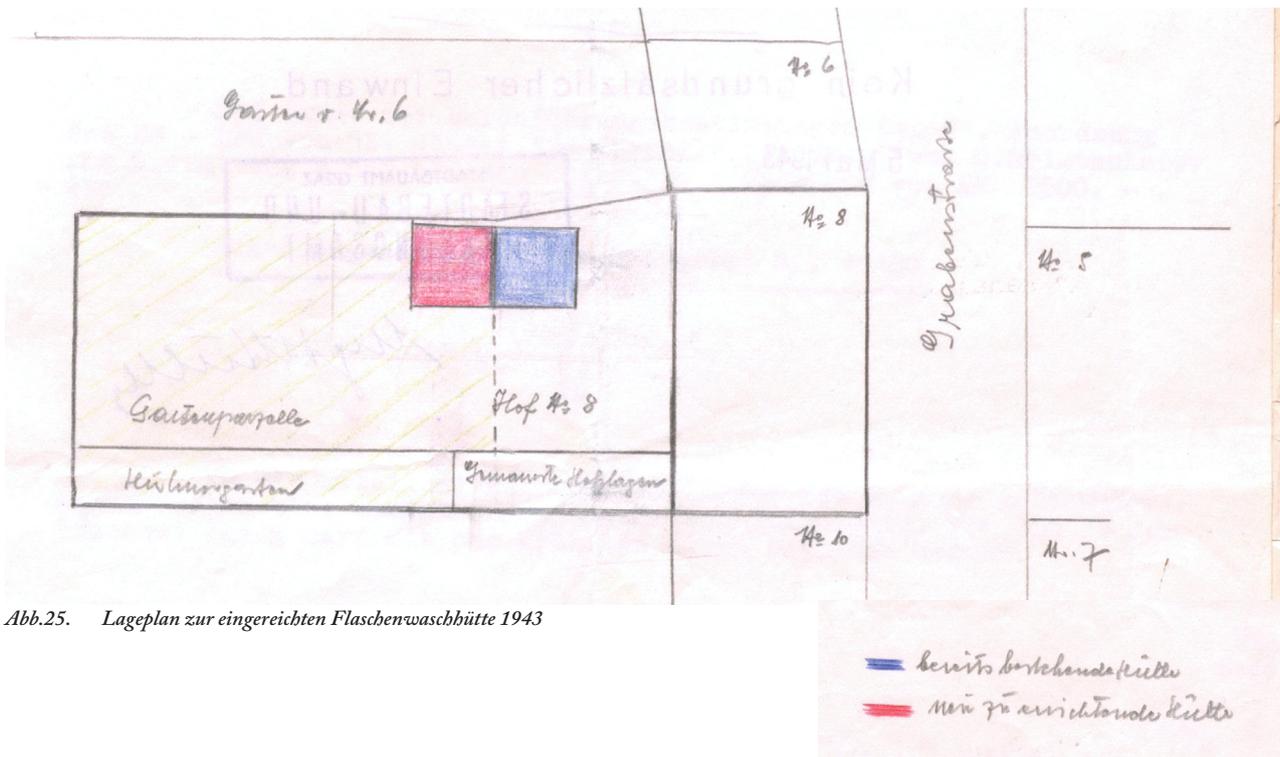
Lageplan zur eingereichten Flaschenwaschhütte 1943
